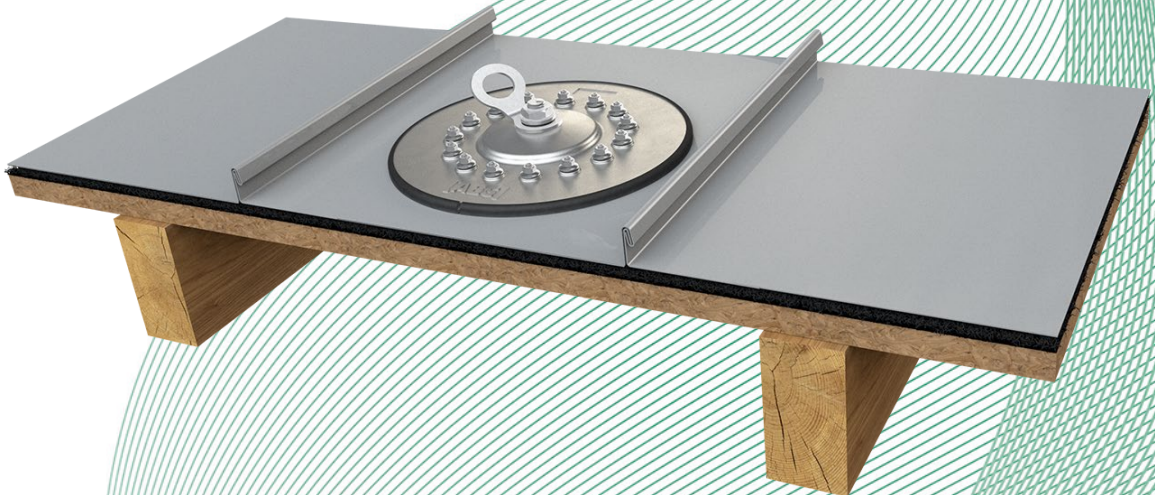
Anschlagereinrichtung, Typ: ABS-Lock® Falz H
